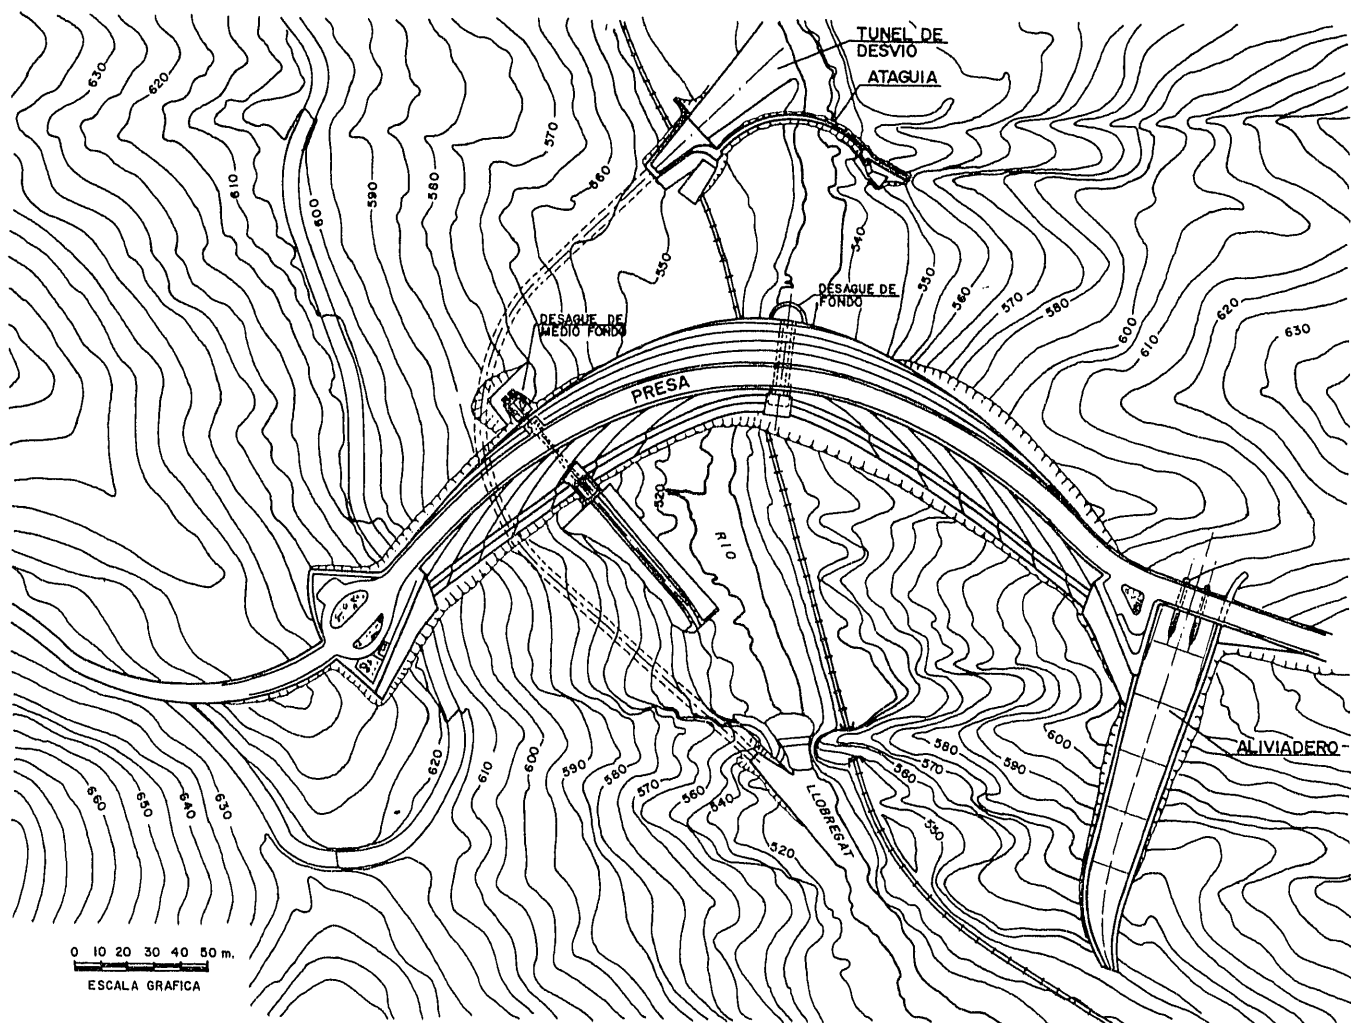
PLANTA GENERAL DE LAS OBRAS
